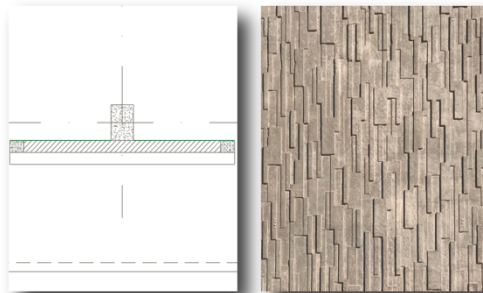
Planta y detalle del material de la fachada. Panel prefabricado. Fuente: Elaboración propia
